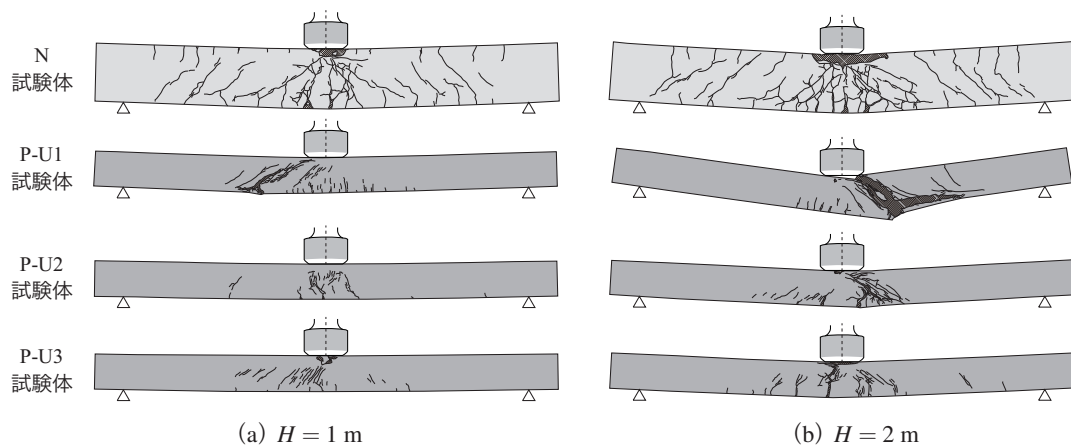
衝撃荷重実験終了後のひび割れ状況
